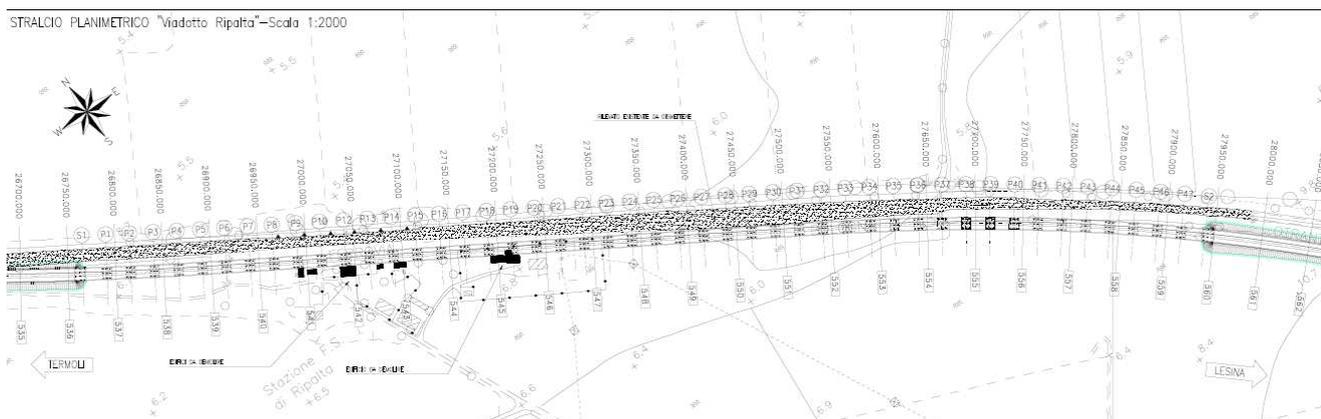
Viadotto Ripalta: stralcio planimetrico
